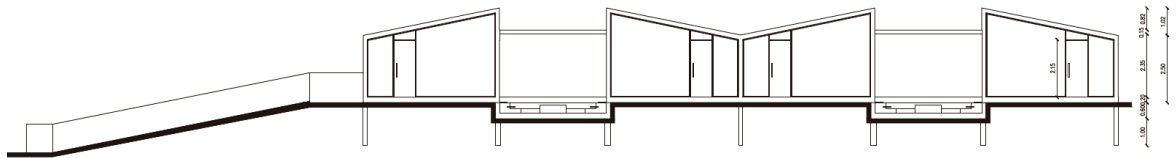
Planta y fachadas arquitectónicas – Habitaciones masters
